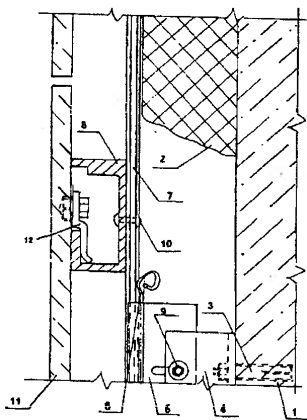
Конструктивная схема облицовки с помощью фиксаторов на распорном анкере:
